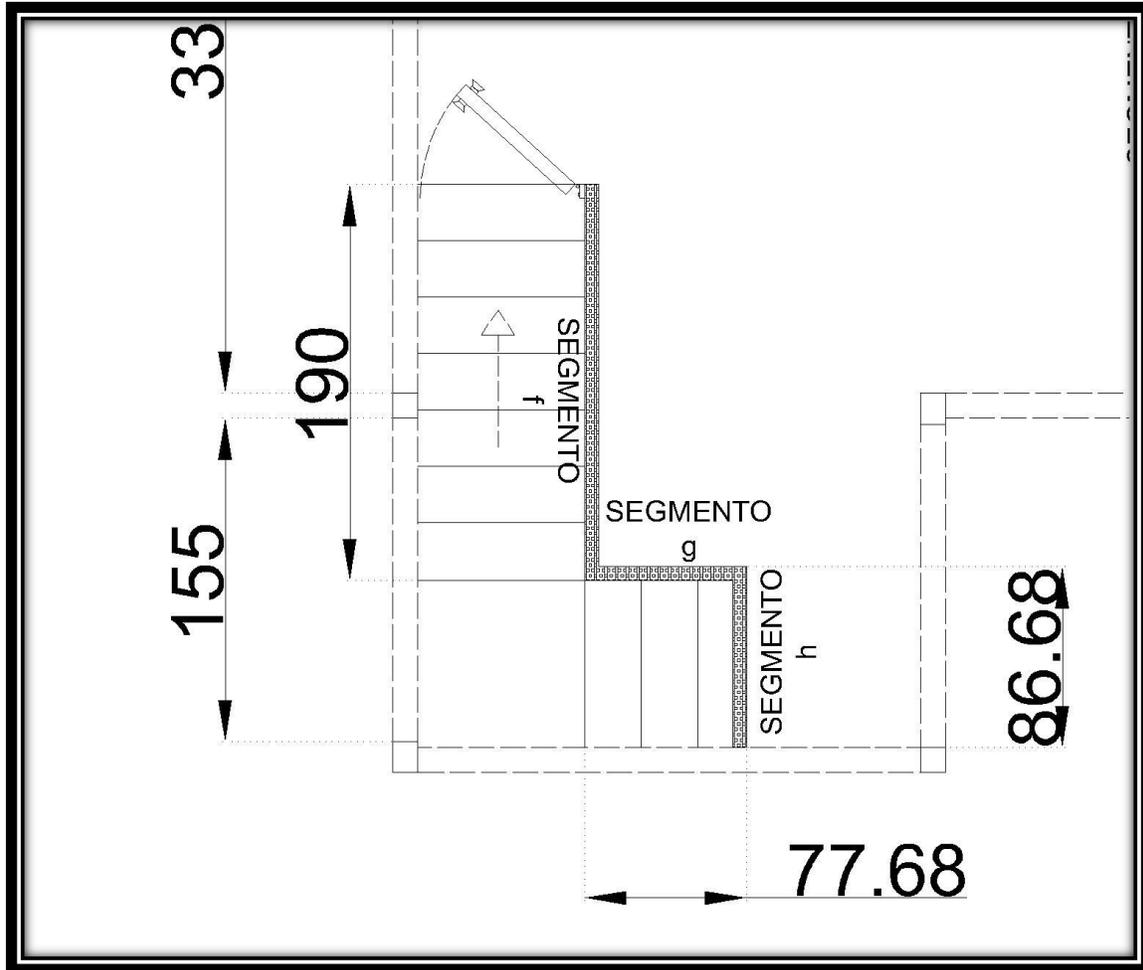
Muros con Paneles de Yeso. Detalle Escalera.
